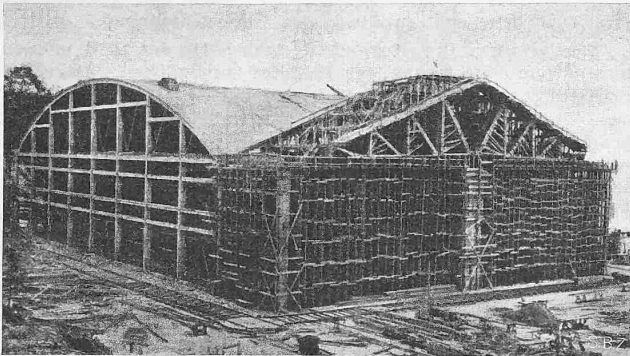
Einrüstung der Quertragkonstruktion (rechts)
